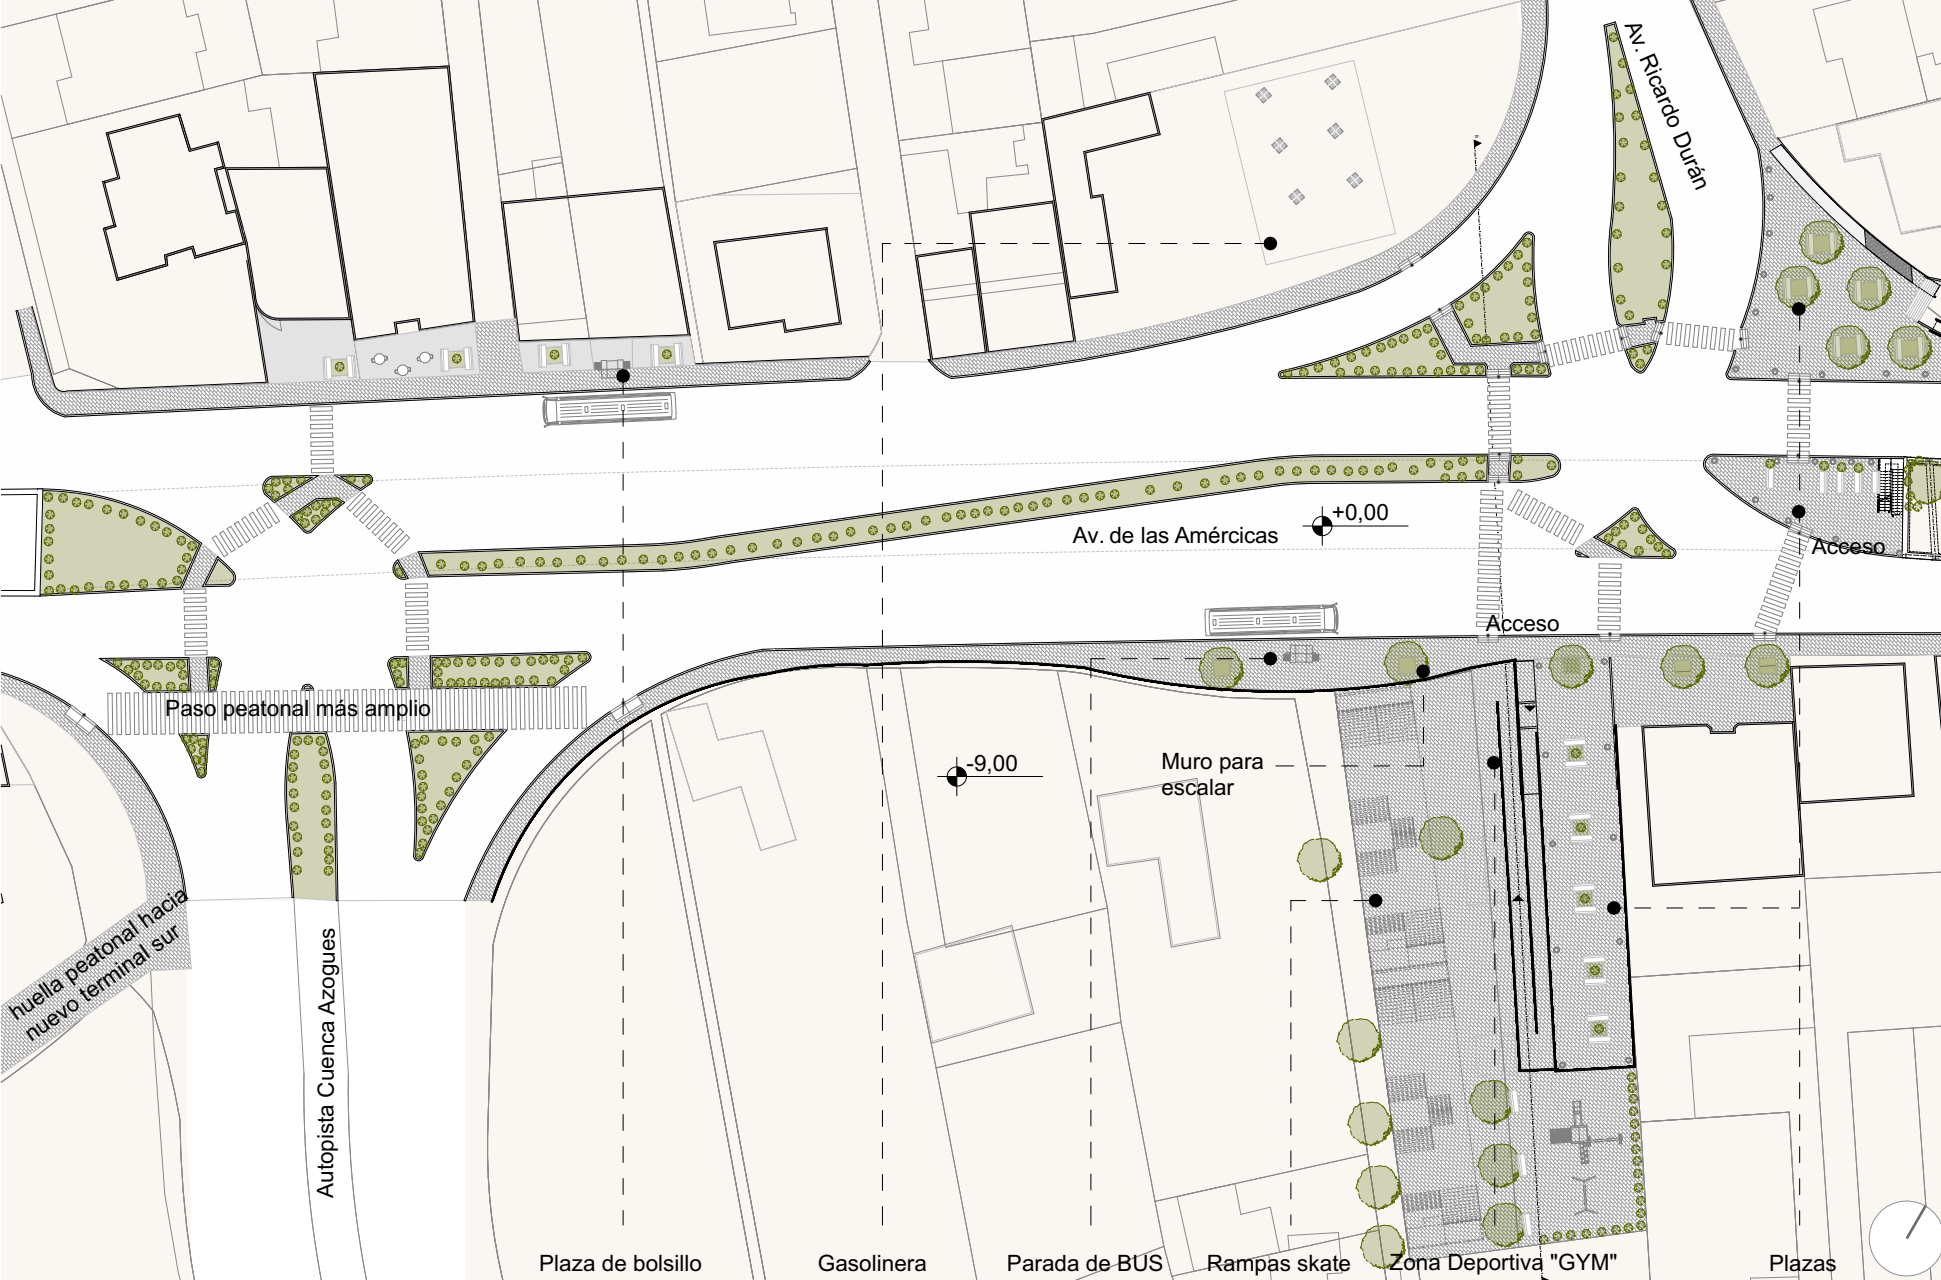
Planta zona deportiva. Elaboración Propia, 2024.
